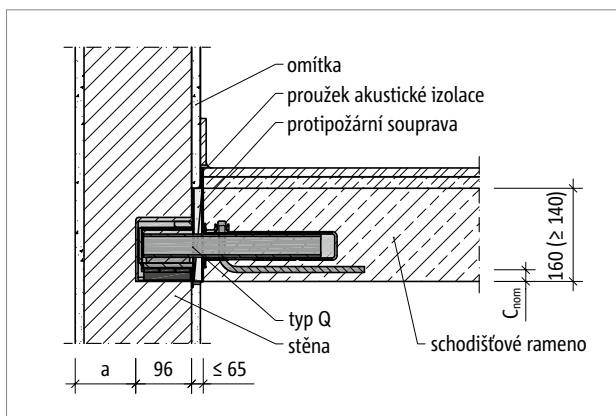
Schöck Tronsole® typ Q: Otvor ve stěně u prefabrikované konstrukce
